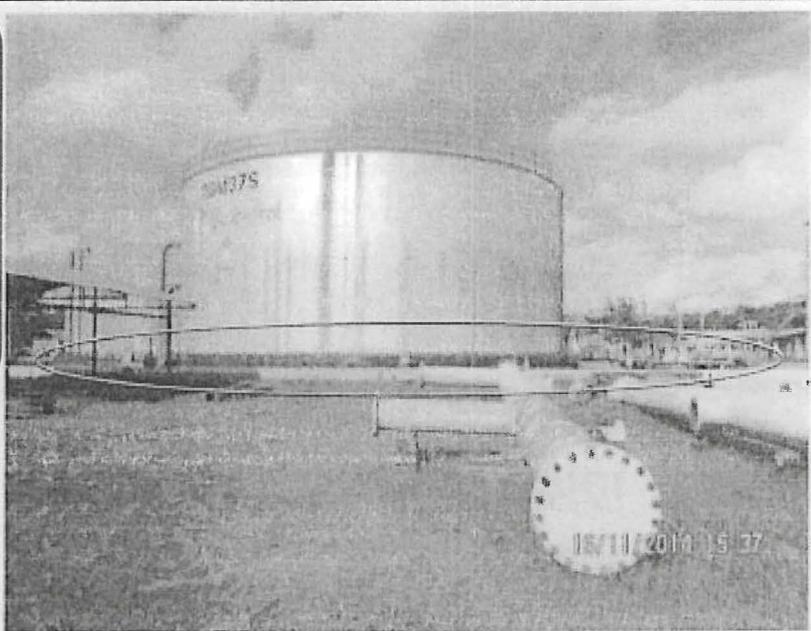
A: Área estanca de tanques 30M37S Bateria 2 (N 9576659, 492632 E).
